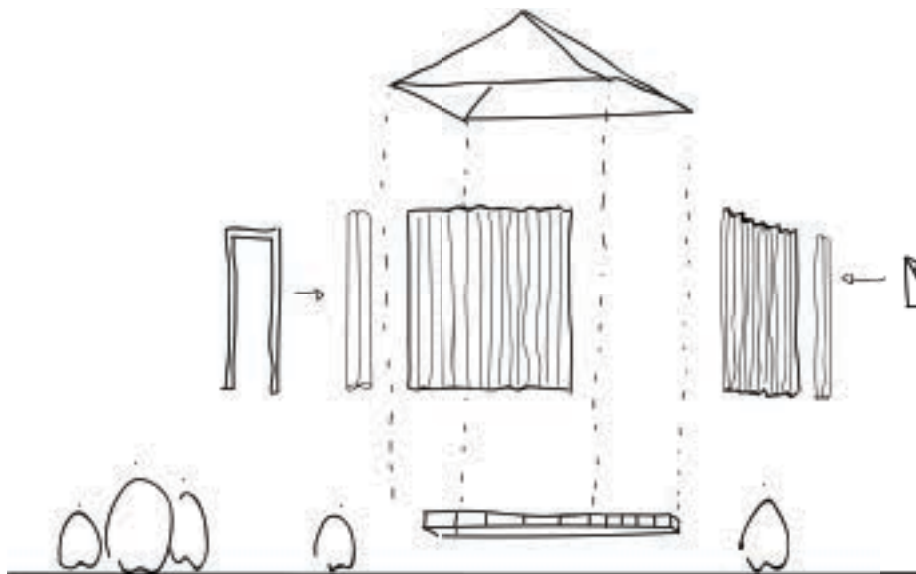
Paper House de Shigeru Ban: Exemplo de modelo A. (Ilustração nossa, 2016).
